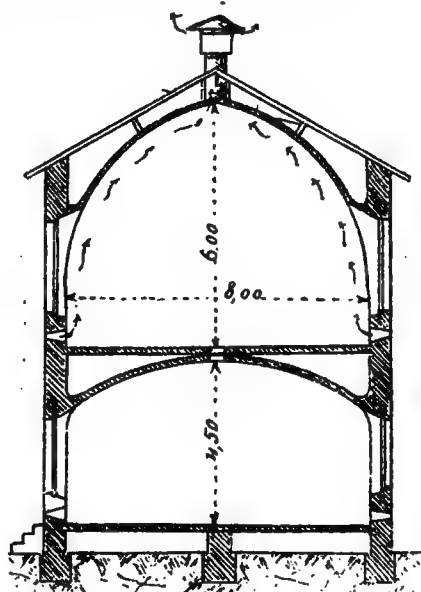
Coupe d'un pavillon à étage (Tollet).
